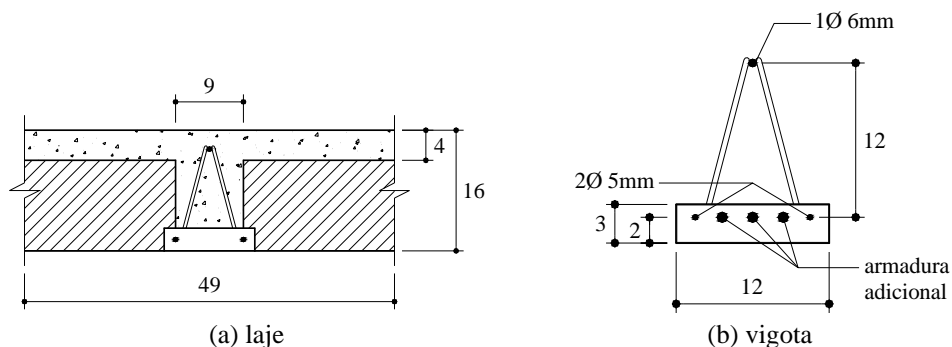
Seção transversal da laje com vão médio (dimensões em cm)
